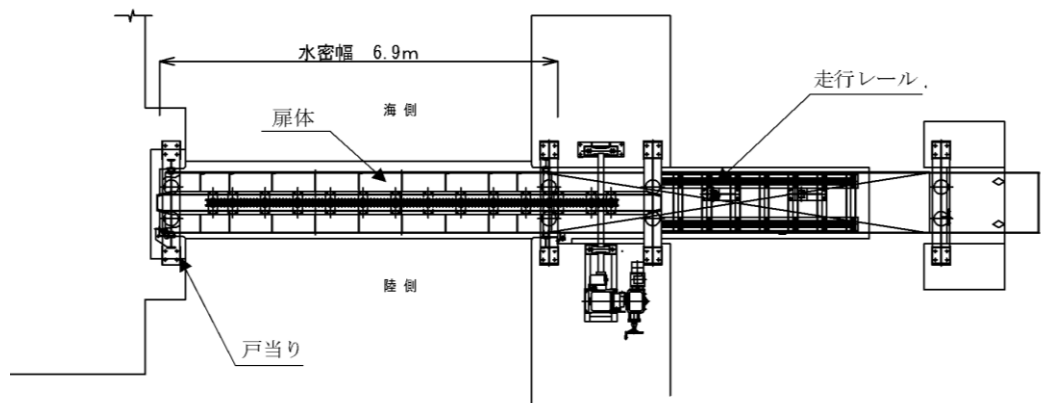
(2) 防波扉の構造図（鋼製扉体，平面図）
